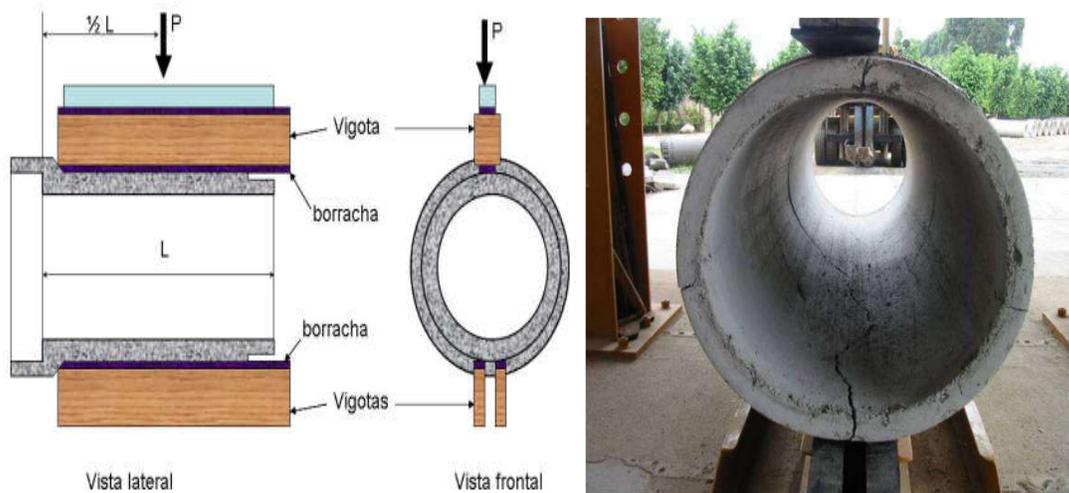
E 8 – ENSAIO DE COMPRESSÃO DIAMETRAL DE TUBOS DE CONCRETO COM FIBRAS PARA ÁGUAS PLUVIAIS E ESGOTO. (FIGUEIREDO, 2008)
